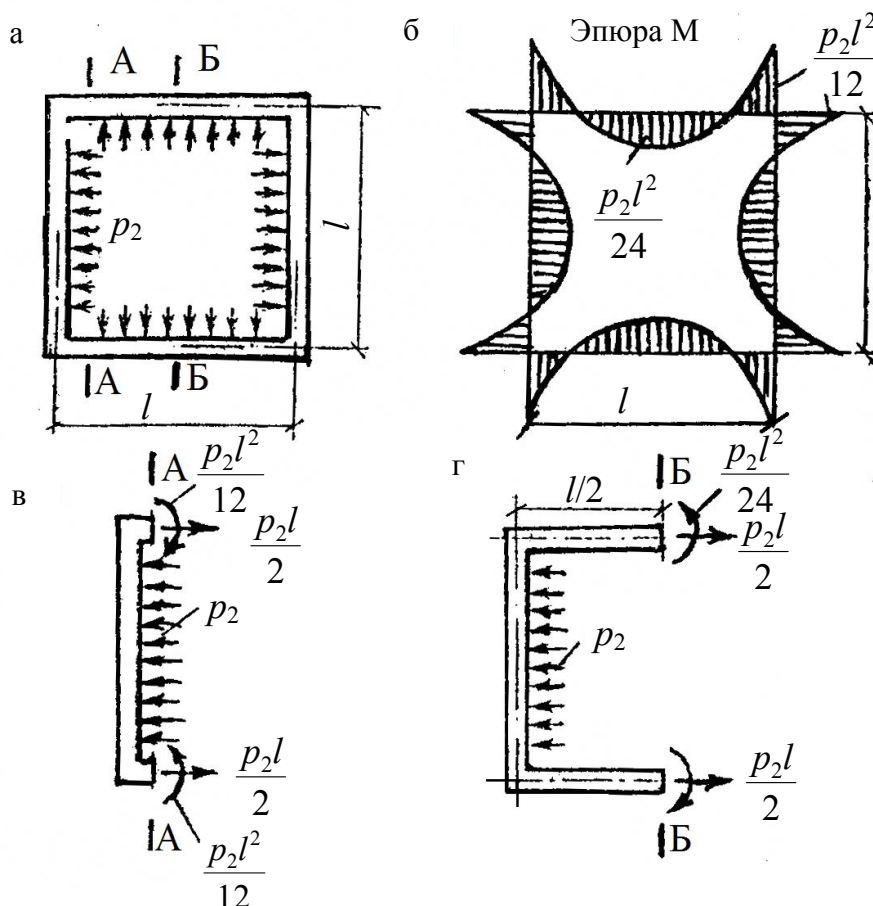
К расчету стен силоса, квадратного в плане:
